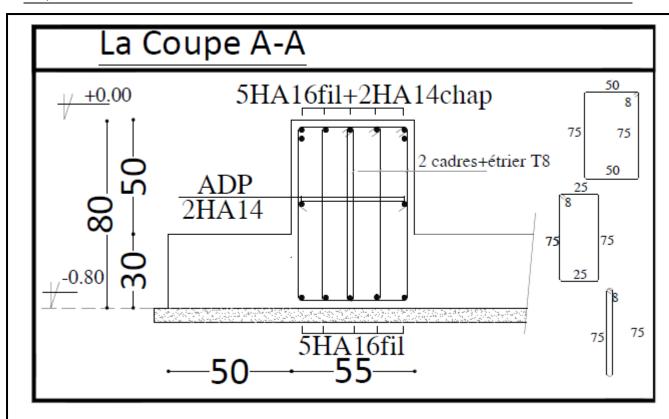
ferraillage de la nervure sens longitudinal
